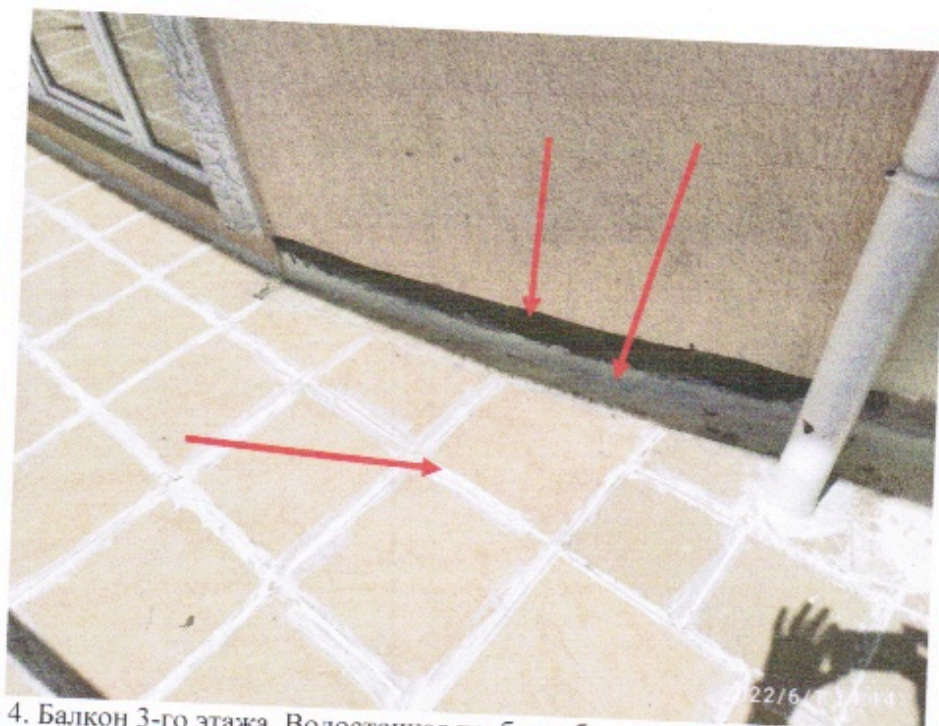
Балкон 3-го этажа. Водосточная труба на балкон 2-го этажа квартиры №1.
